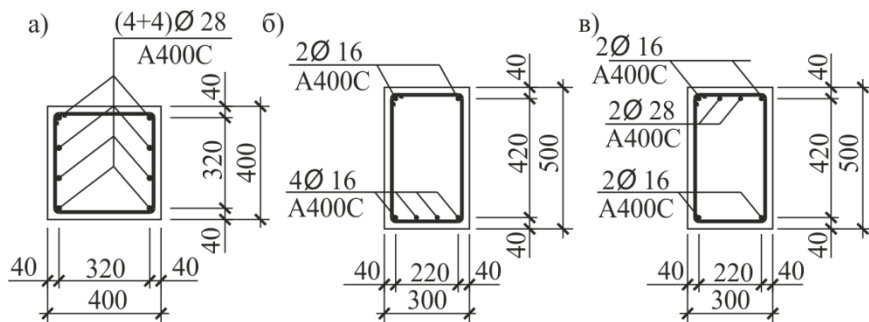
Армирование элементов железобетонного рамного каркаса:
